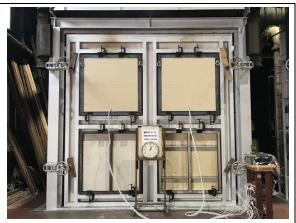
試験体 1-1,1-2 非加熱面・加熱終了時(60分)
